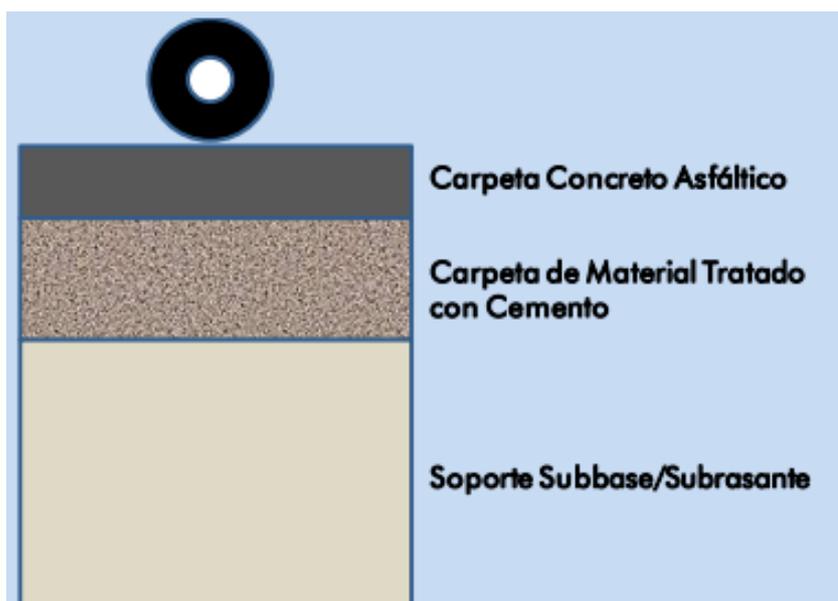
Seção Transversal Típica de Pavimento Semirrígido.
